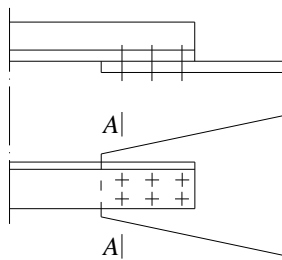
Расположение проверяемого на выносливость расчетного сечения А – А по основному металлу в сечении брутто по первому ряду высокопрочных болтов в прикреплении к узлу или в стыке одностенчатых элементов с односторонними накладками
